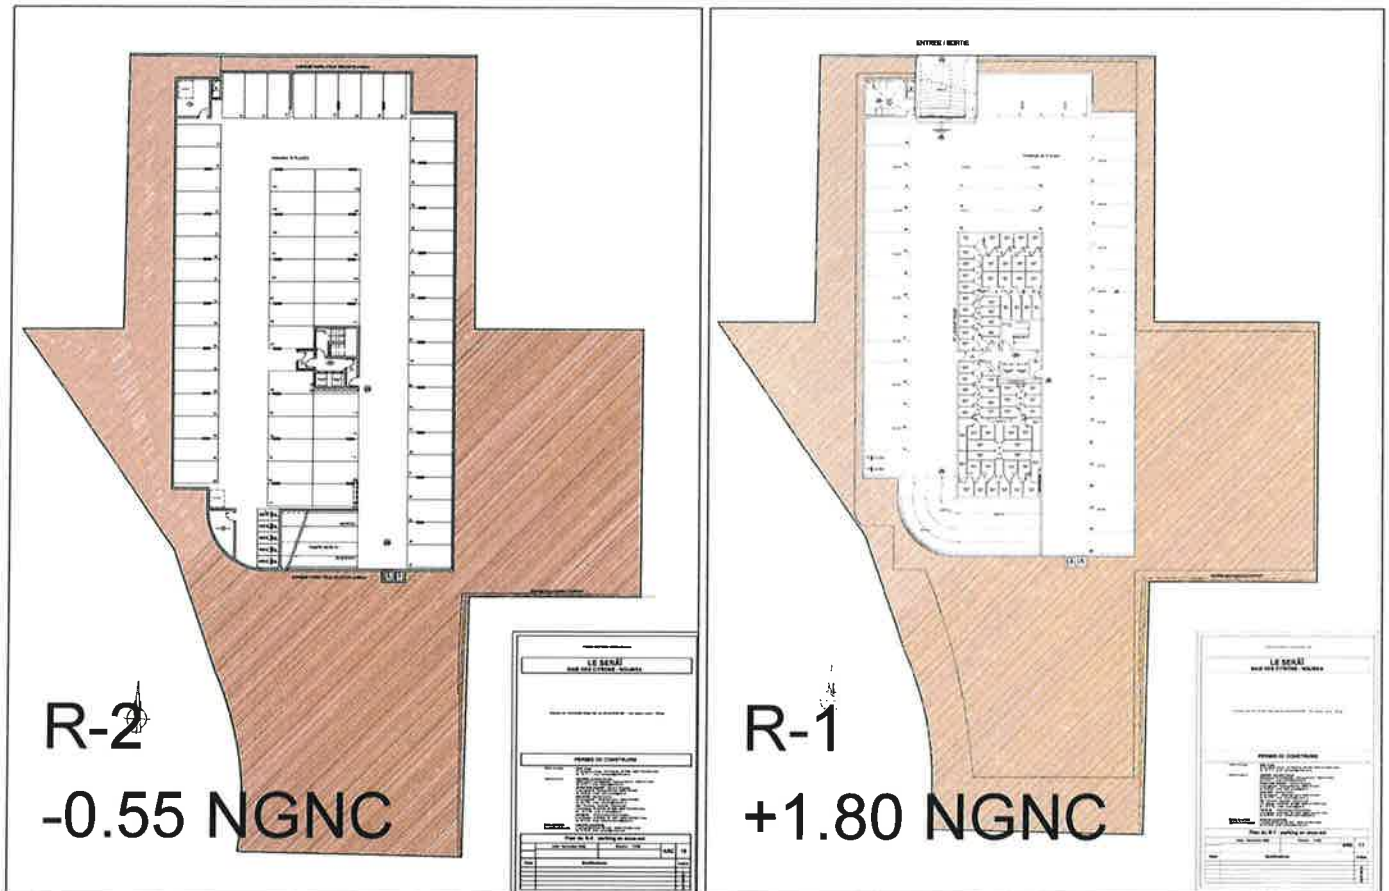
Emprises des niveaux R-1 et R-2 (Plan 01/12/2020)
